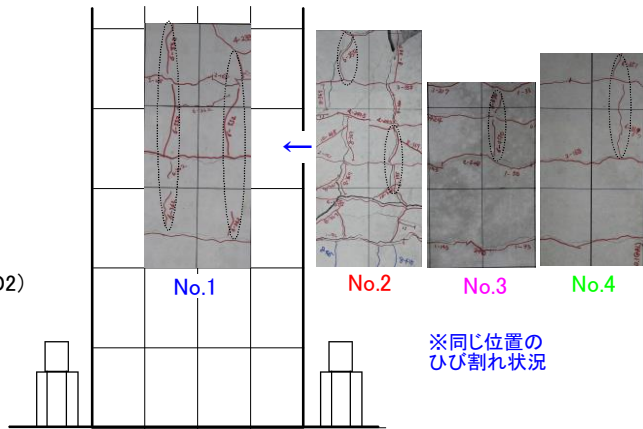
引張を受ける面のひび割れ状況 (主筋に沿ったひび割れ)
